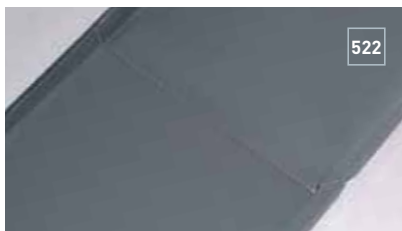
DETAIL FALZAUSLÄUFE BEI SENKRECHTER WINKELSTEHFALZFASSADE
